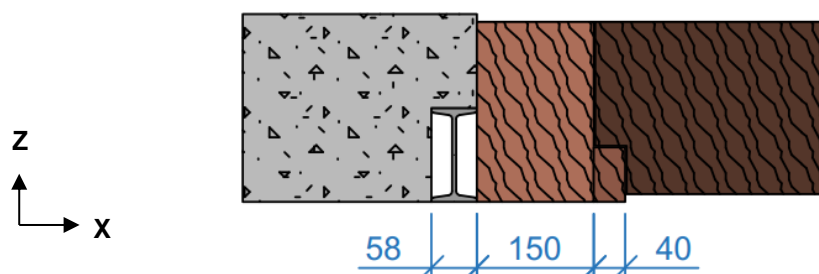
Coupe de la poutre de l'ancienne trémie (9)
